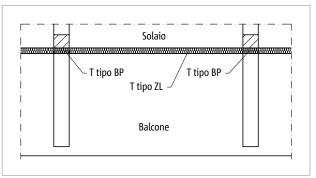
Schöck Isokorb® T tipo BP: balcone con travi ribassate a sbalzo
